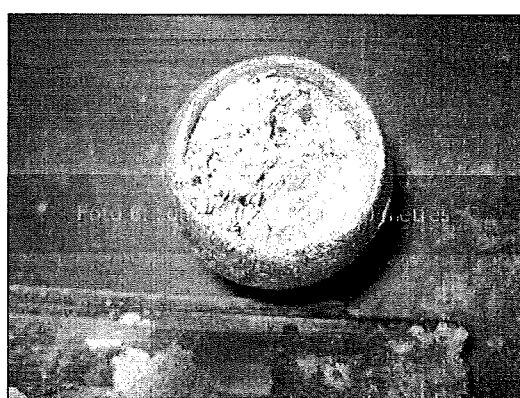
Sondeig S-3. SPT a 1,5 metres.
